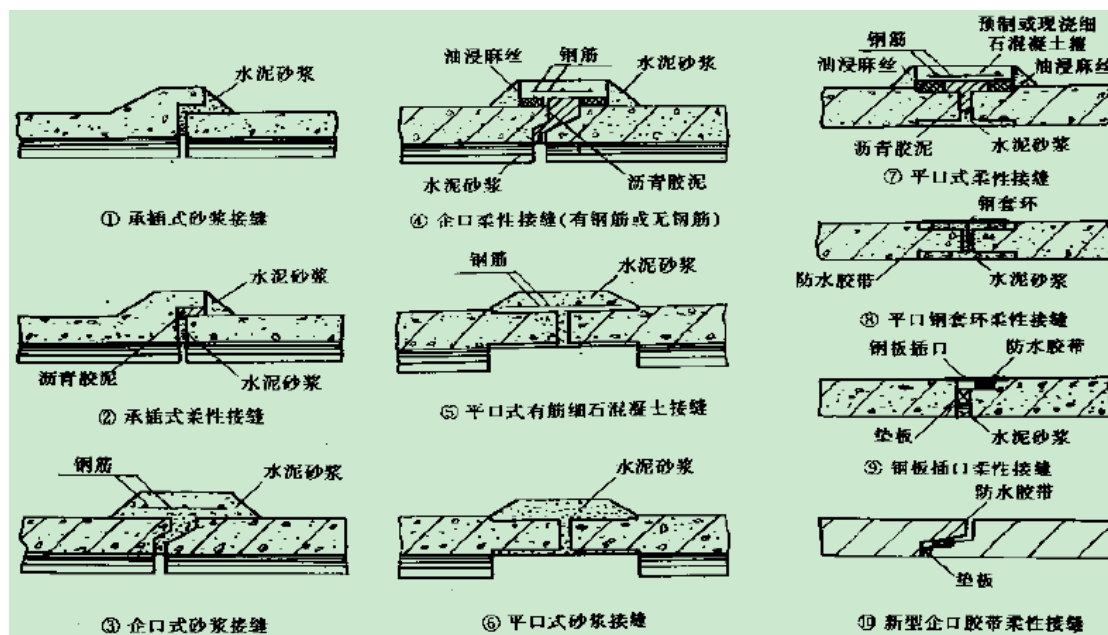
混凝土及钢筋混凝土排水管道各种接头
